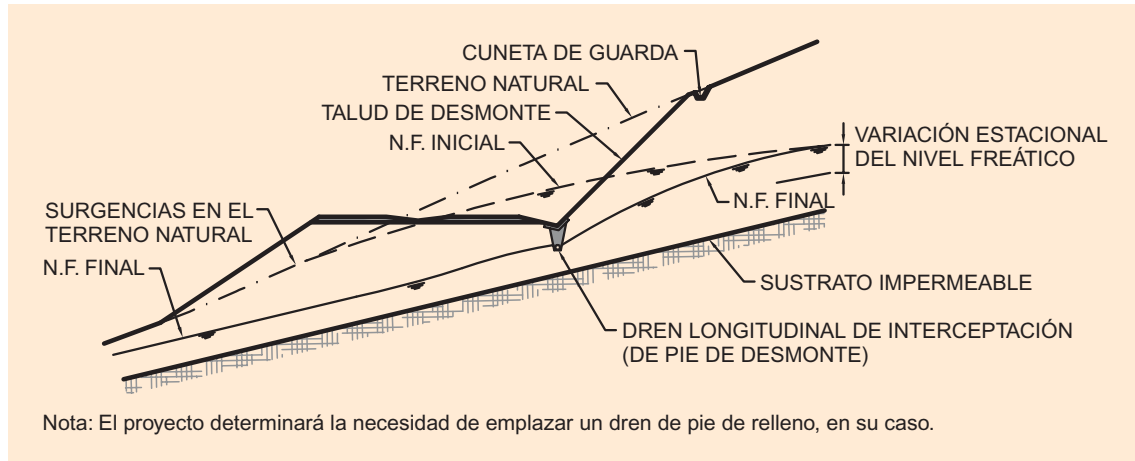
EJEMPLO DE DREN LONGITUDINAL DE INTERCEPTACIÓN
